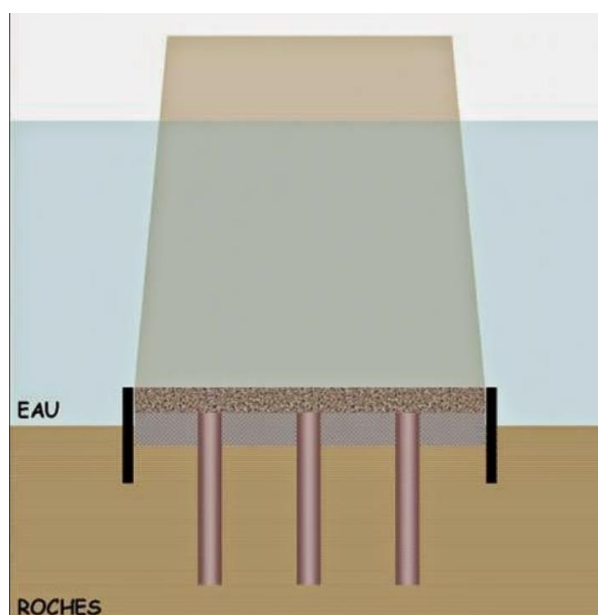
Schéma en coupe de construction des piles : pile terminée.
